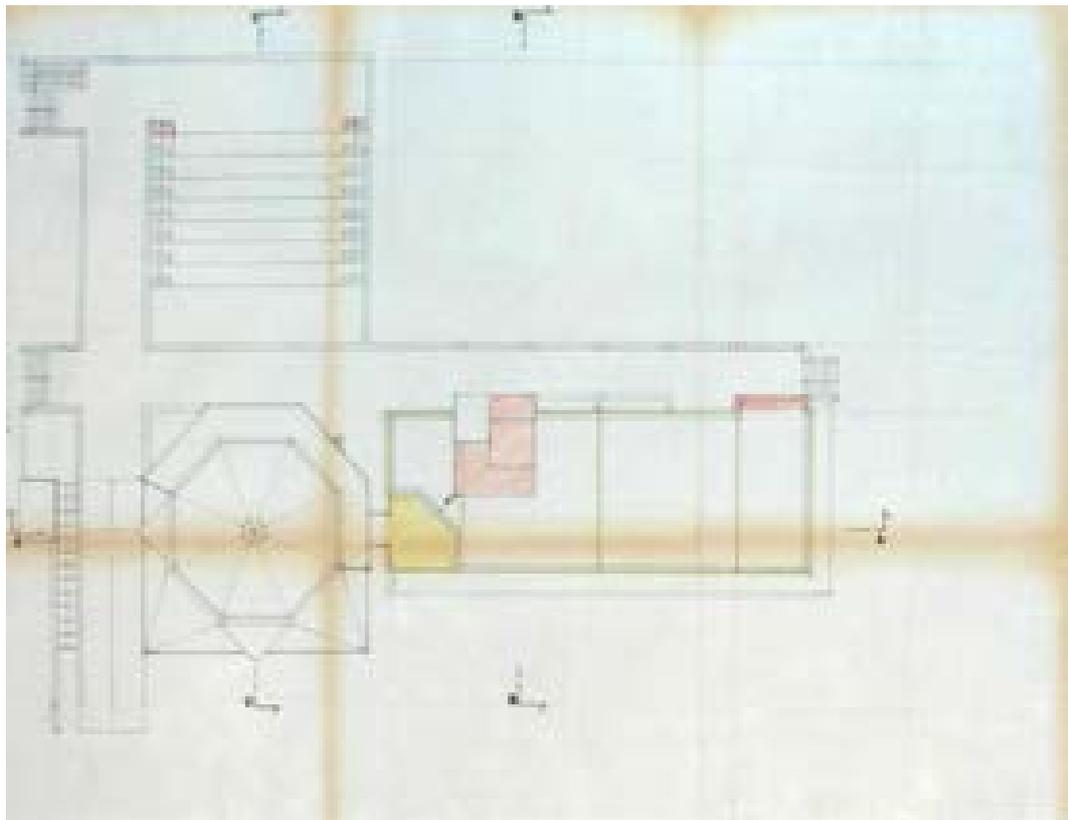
Pianta coperture, stato sovrapposto – 28/03/1995 (AABS-64_836)
